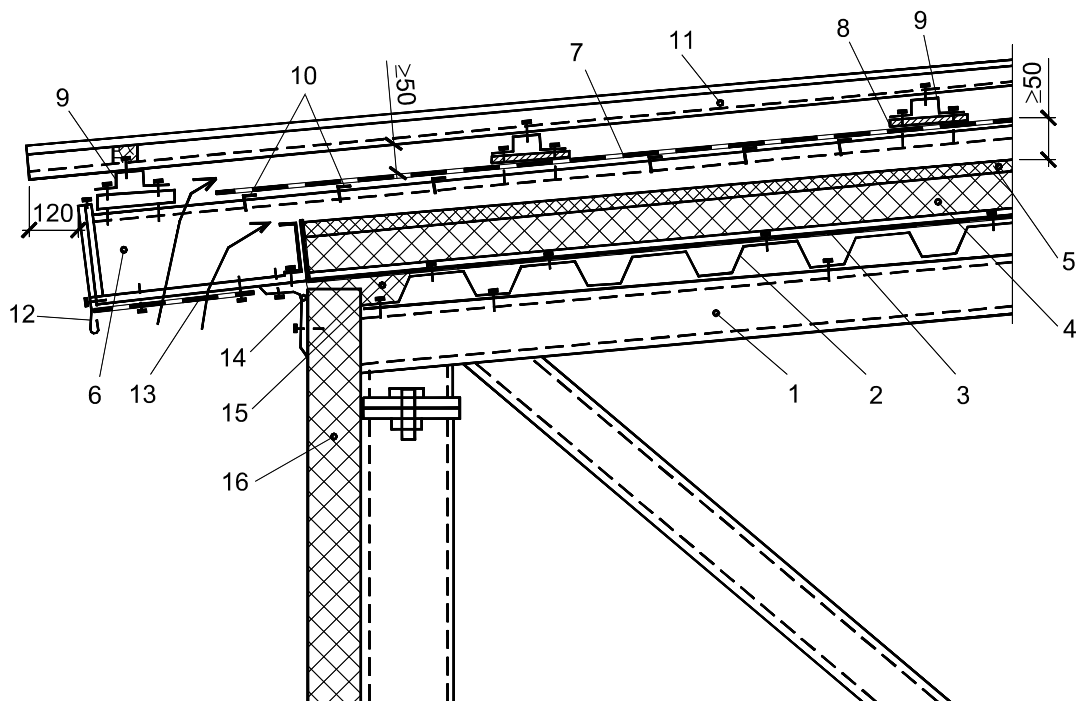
Вариант устройства карниза «теплой» кровли из стального профилированного настила с двумя вентилируемыми воздушными прослойками
